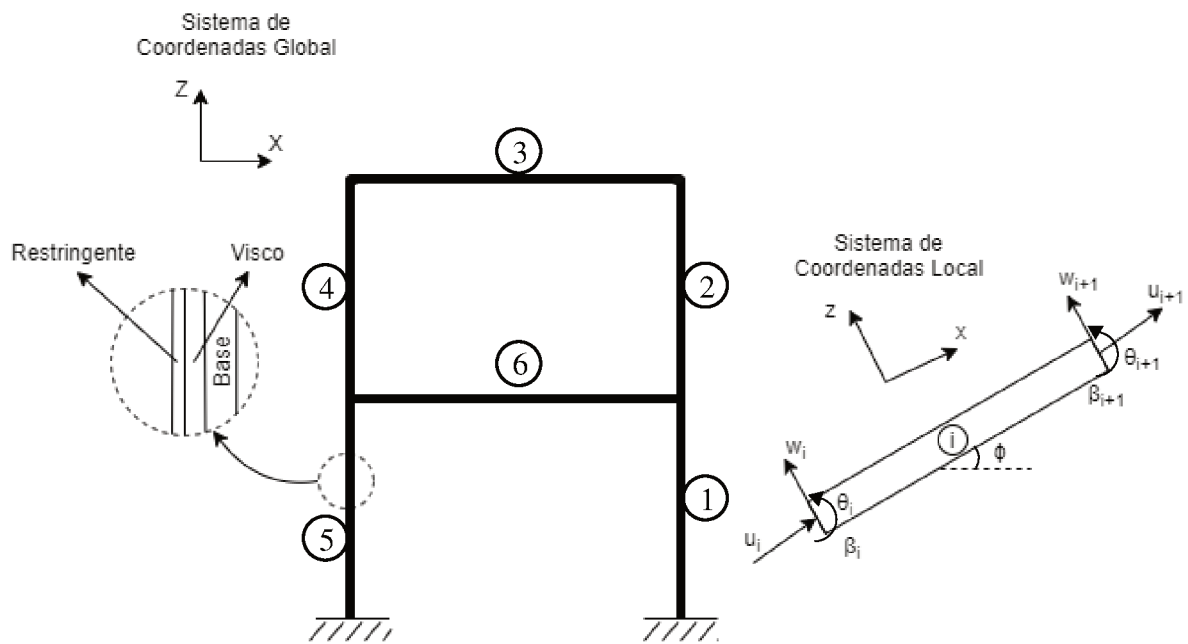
Pórtico plano tratado com viga sanduíche e um elemento genérico
